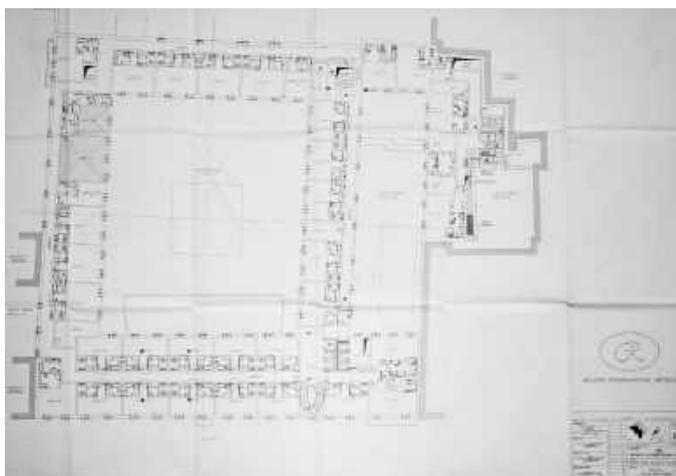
Pianta piano primo, progetto di restauro e riuso; tavola su carta
